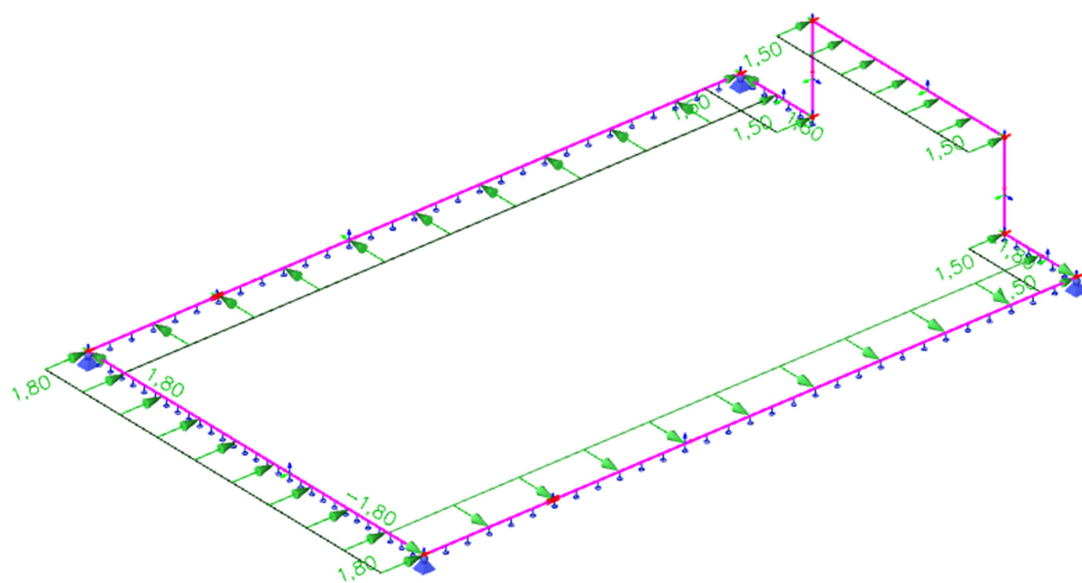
Konstrukce 3, Zatěžovací stav ZS3
